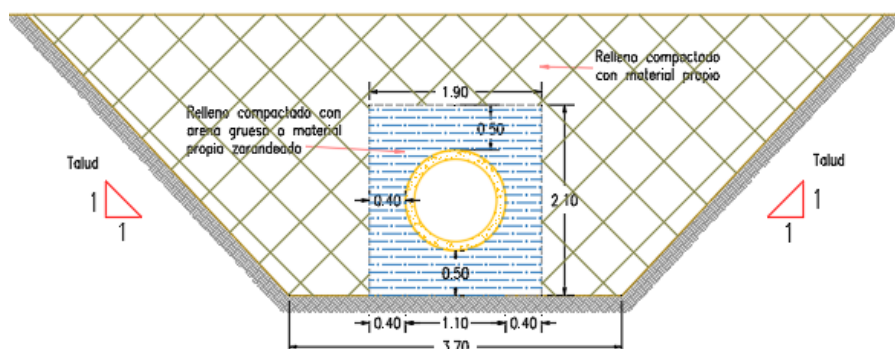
Detalle de relleno de zanja para tubería ONP.
